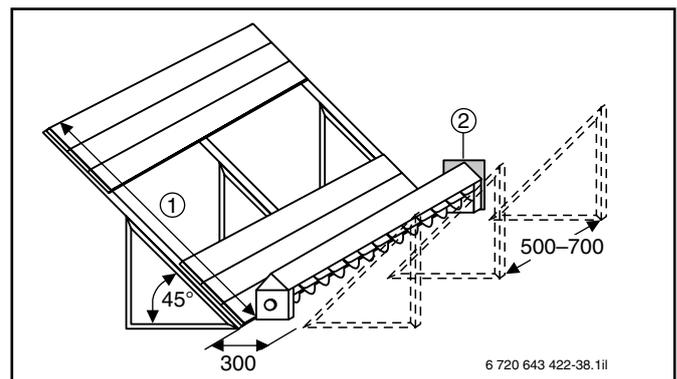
Montaggio della vite direttamente al pavimento (quote in mm)
